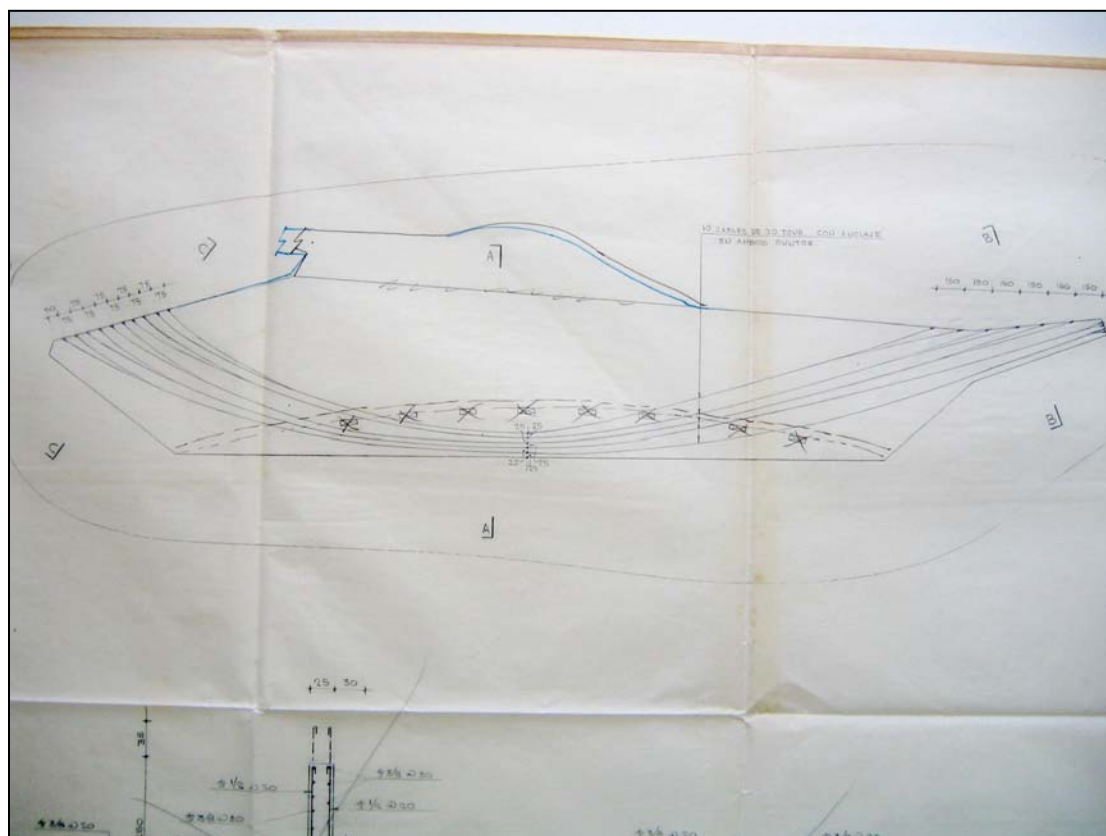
, 32 Planos cimentación, Torres del Parque. Fuente Archivo Parma Universidad de los Andes
